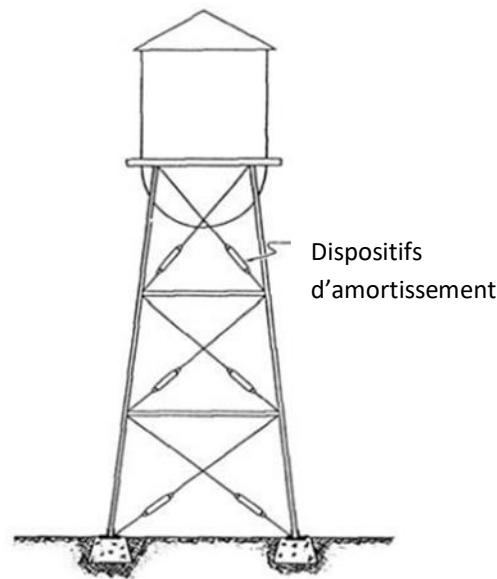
Château d'eau avec dispositifs d'amortissement
